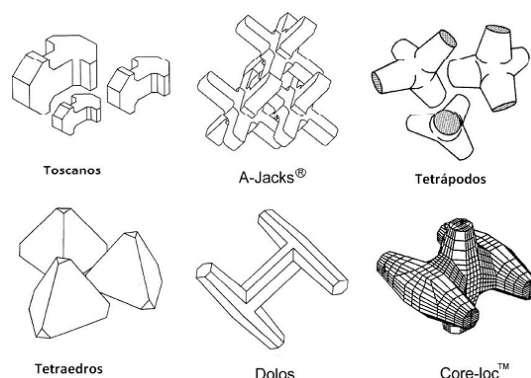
Blocos de concreto com geometrias diversas pra proteção de pilares de pontes contra a erosão.
